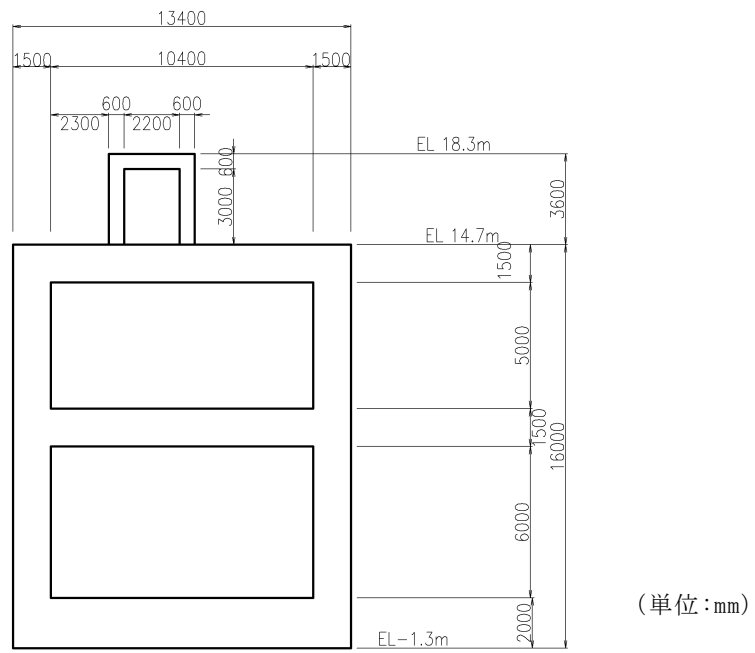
低圧原子炉代替注水ポンプ格納槽 断面図 (A-A断面)
